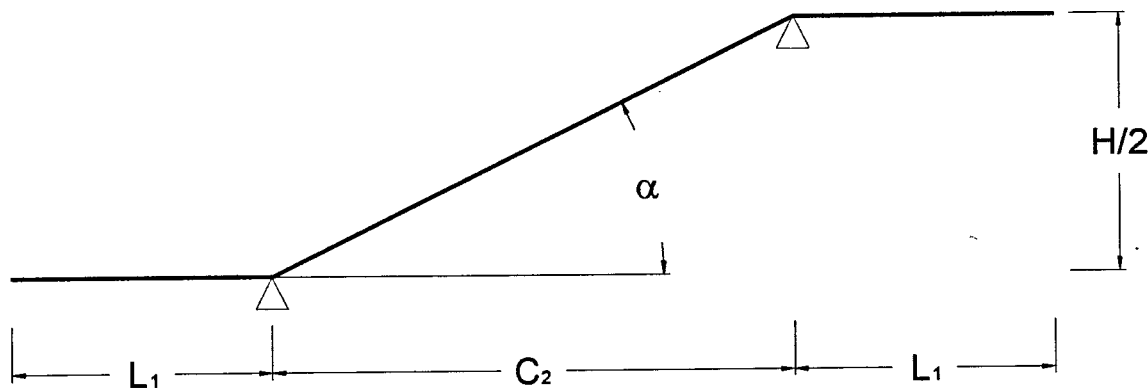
ESQUEMA ESTRUTURAL DA VIGA LANÇO
